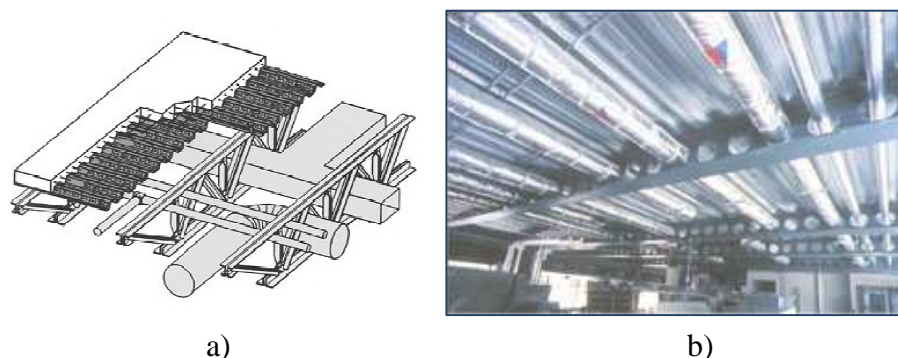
a) Vigas mistas com recurso a treliça (tipo *joist*), b) Vigas alveoladas: Pormenores ilustrativos da facilidade de introdução de instalações em geral.
